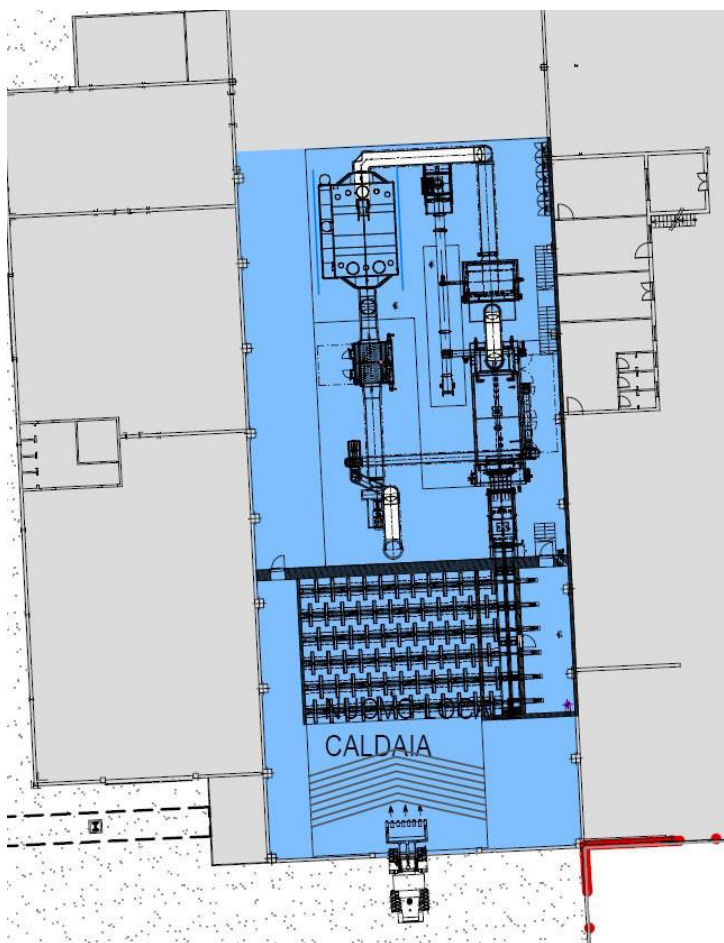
layout interno impianto a biomassa – Maggio 2022 (progetto attuale – dettaglio)
